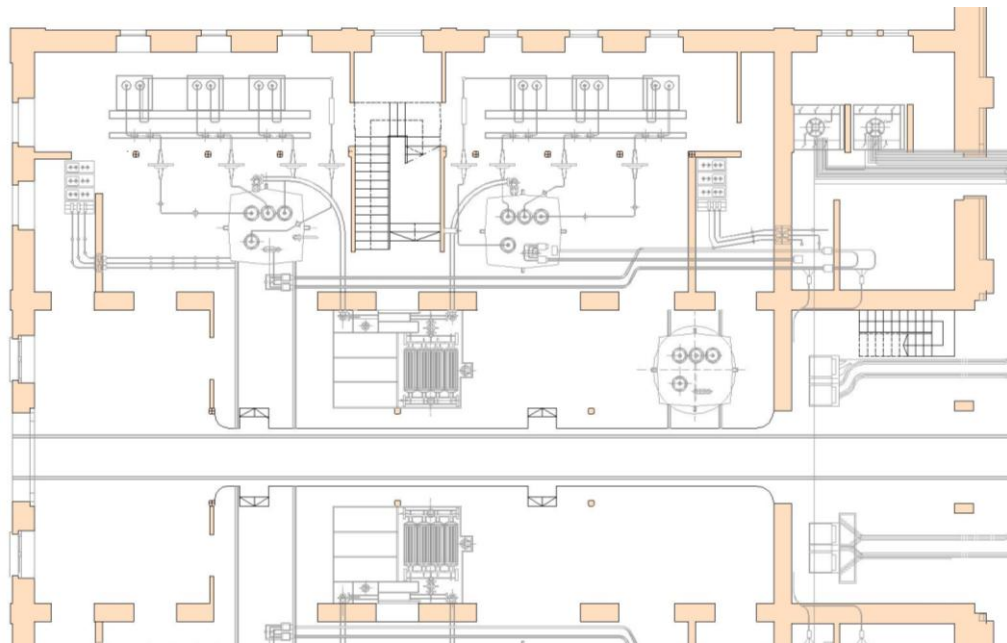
Planta de distribución realmente ejecutada de la Planta Baja. Edificio de Transformadores. Levantamiento in situ de la ruina. 2014. Suposición de la ubicación de la maquinaria eléctrica.
